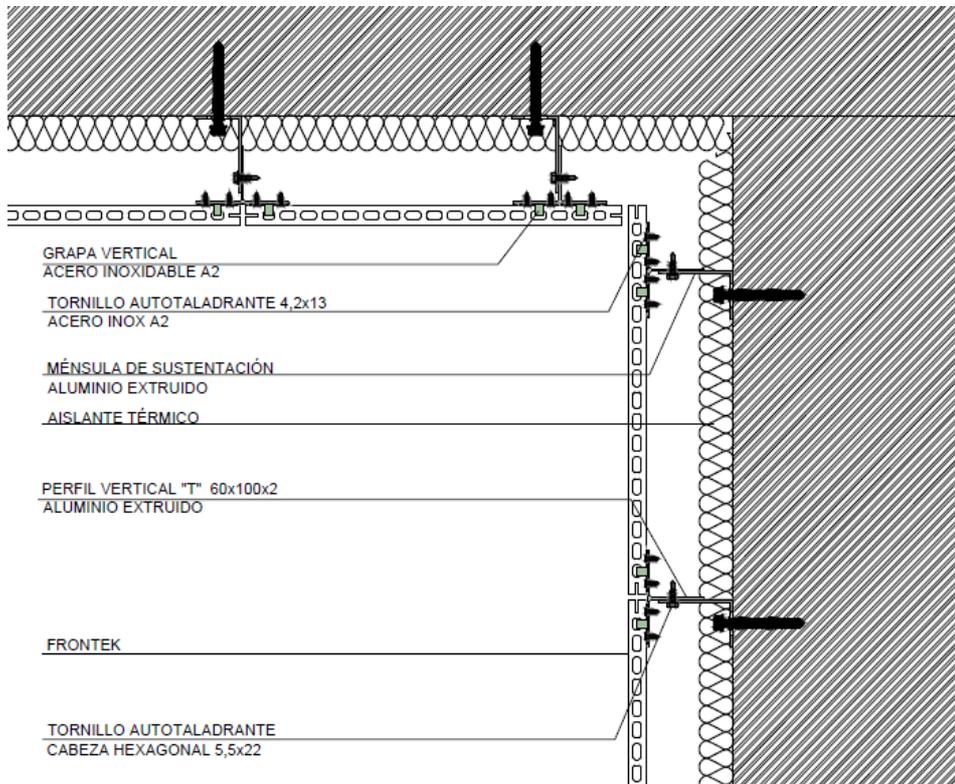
JUNTA DE DILATACIÓN – SECCIÓN VERTICAL
